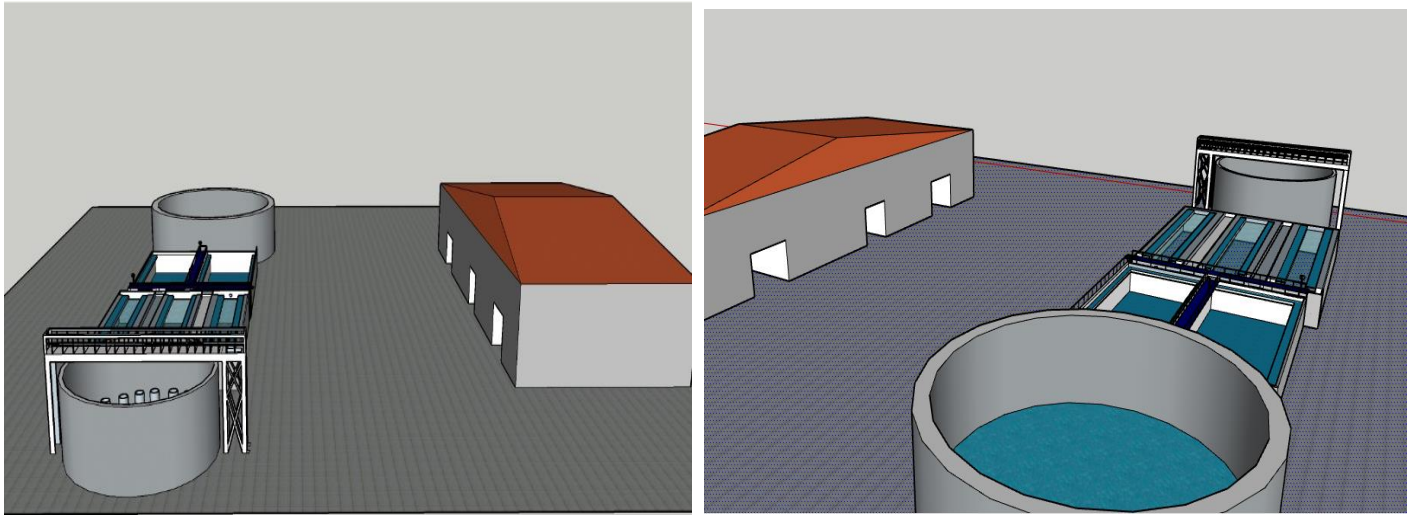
Infraestructura de la planta de Enacal. Fuente propia.
